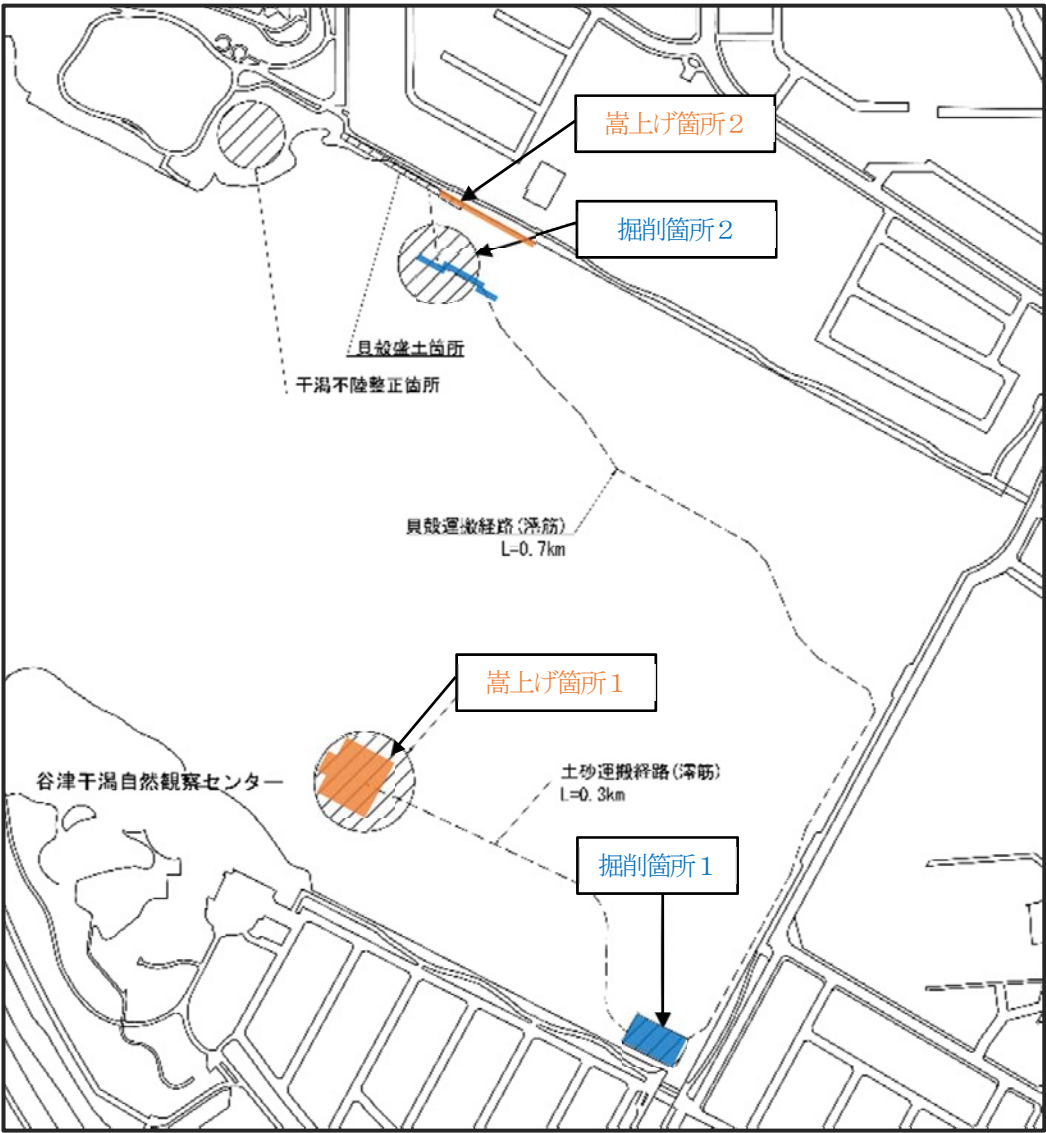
平成 31 年度干潟掘削・嵩上げ工事実施箇所平面図
